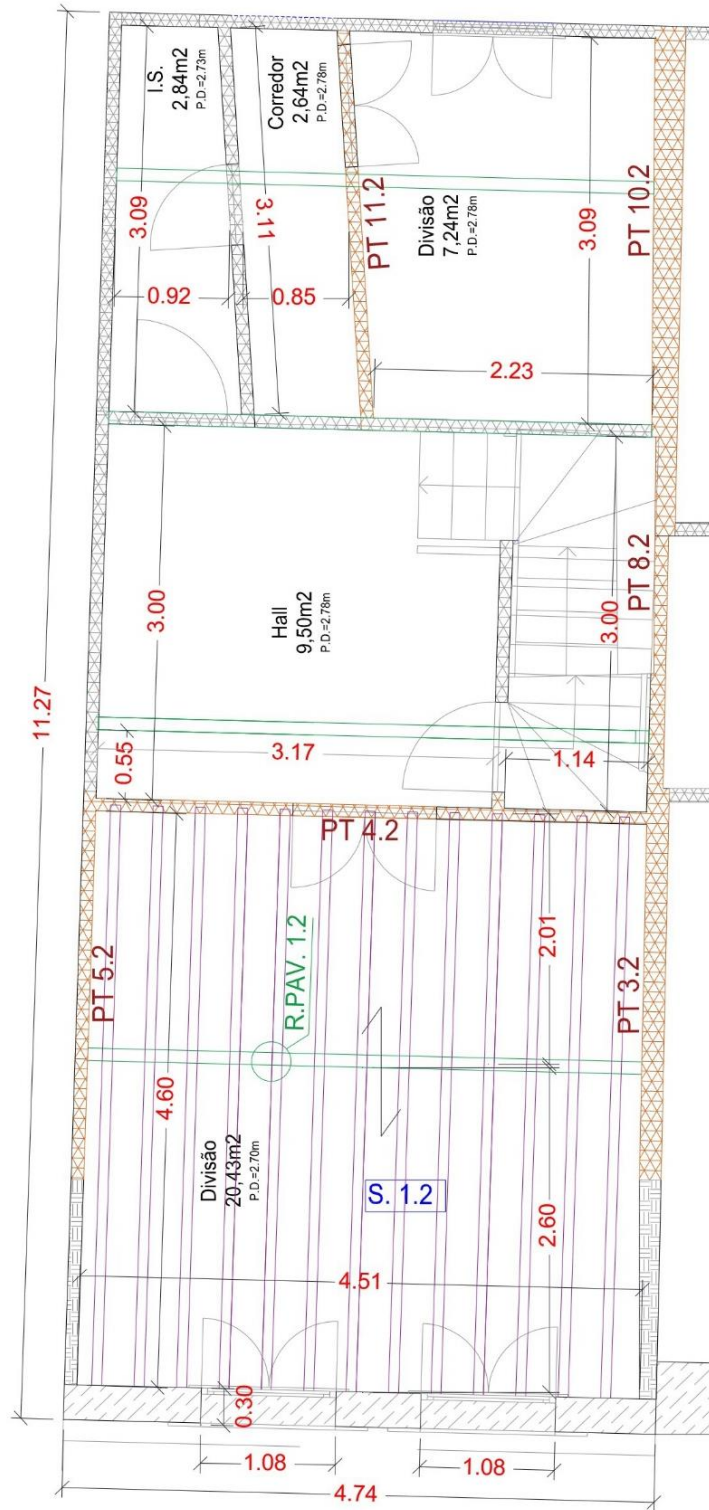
Disposição das vigas no pavimento do Piso 3
